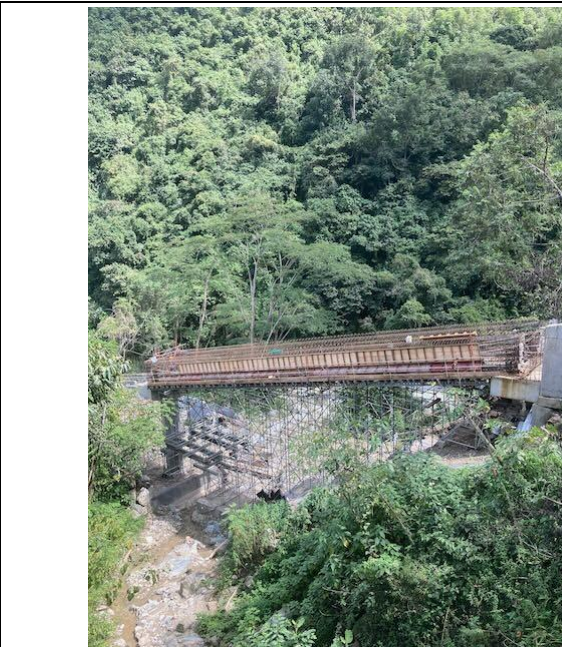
Puente en la carretera de acceso de la autopista a la casa de máquinas
